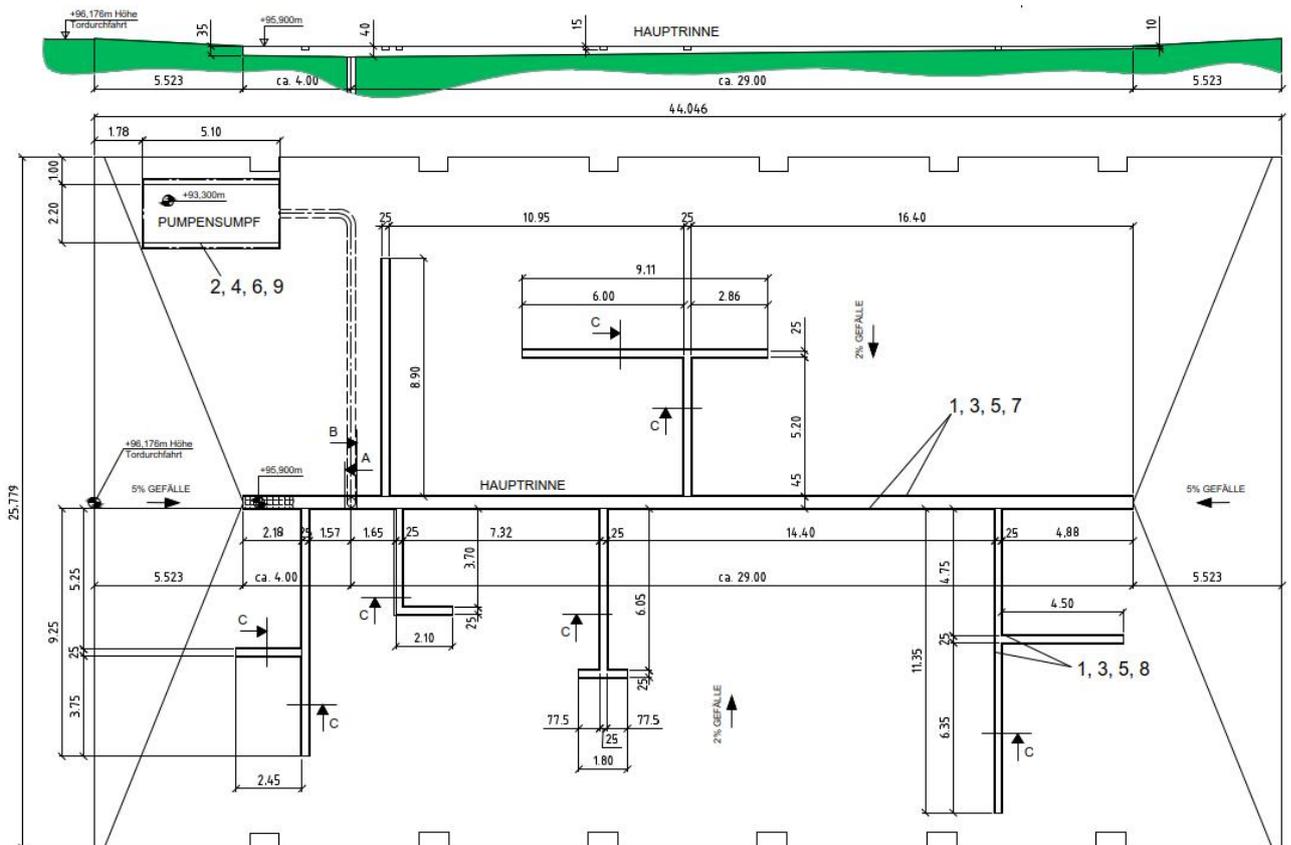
Grundriss Gebäude 7 Entwässerungs- und Gefälleplan Ing.-Büro WES MA-255-B-025 vom 06.03.2020
